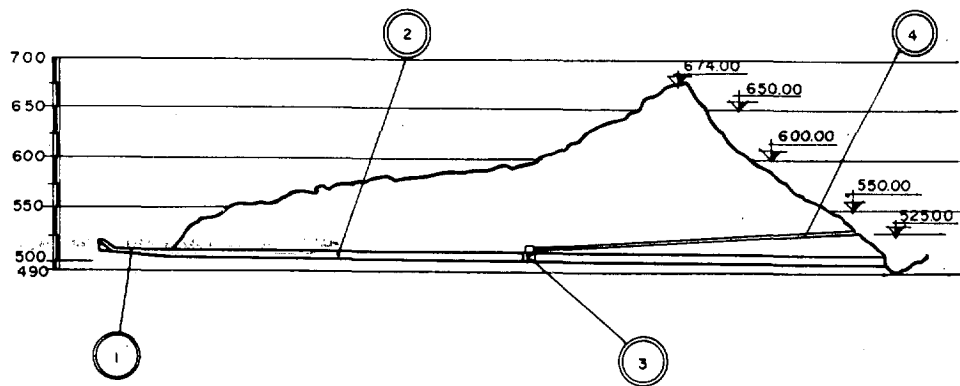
Perfil longitudinal desvío del río y desagües de fondo: 1, embocadura; 2, túnel; 3, cámara de llaves; 4, galería de acceso cámara mecanismos.
